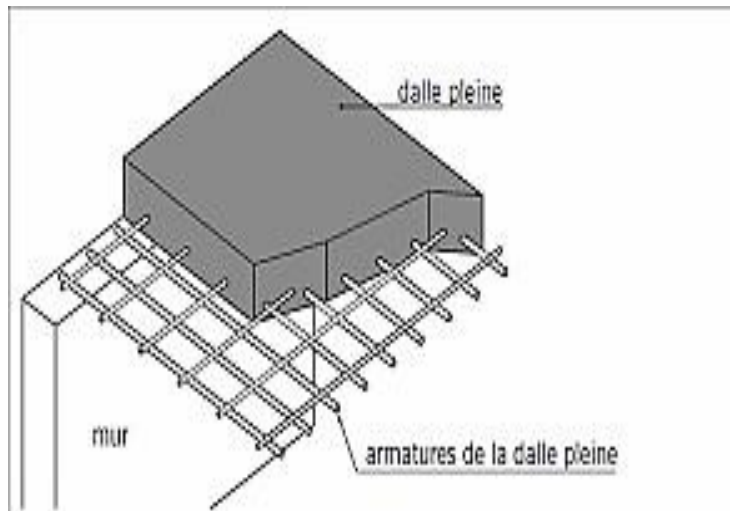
Schéma descriptif d'un plancher a dalle pleine
